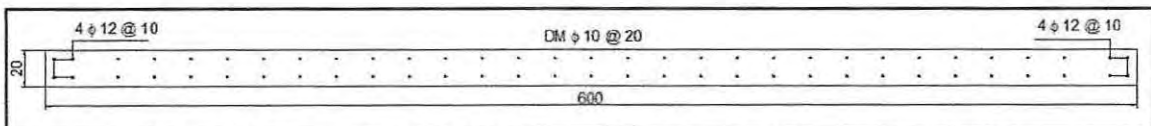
Armadura de flexo-compresión Muro 1, Estructura II (Aislada).
